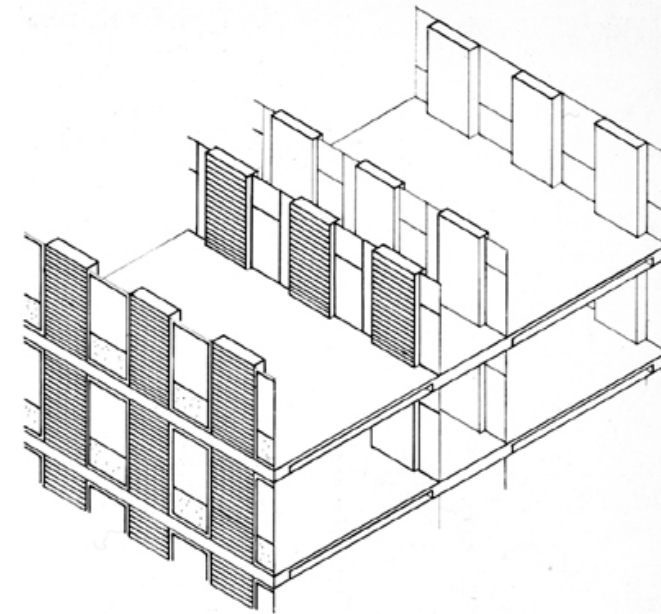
Bürohauskonstruktion in Mauerwerk
